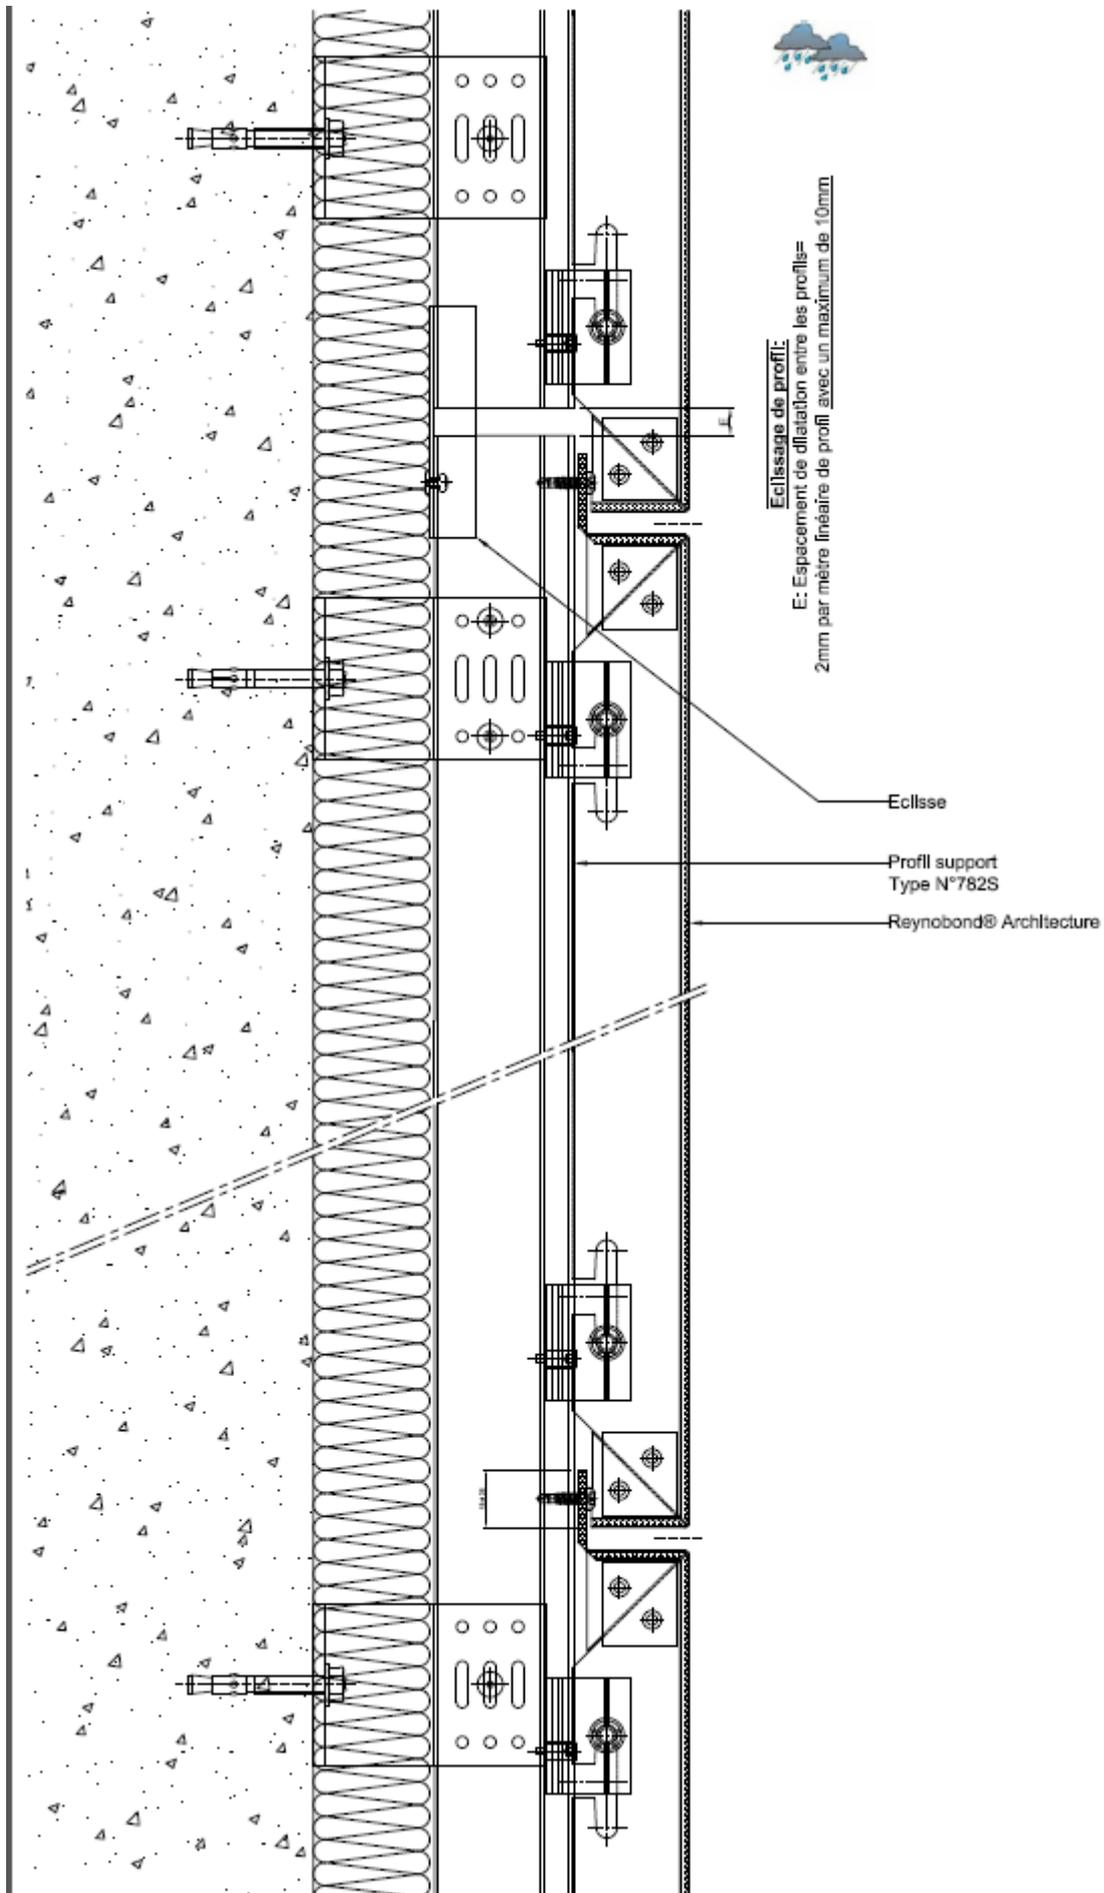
Emplacement du raccord de dilatation entre les éléments d'ossature – Coupe verticale
